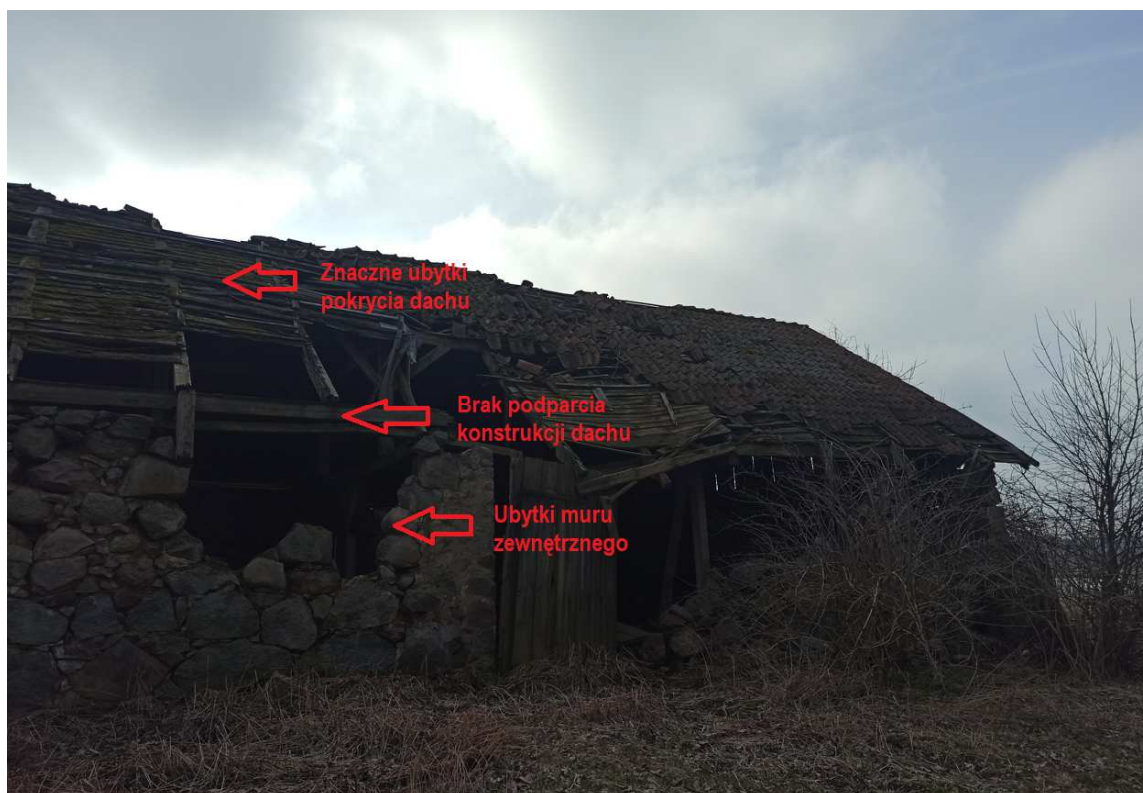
Widok elewację drugiego szczytu – od strony zachodniej przedmiotowego budynku
